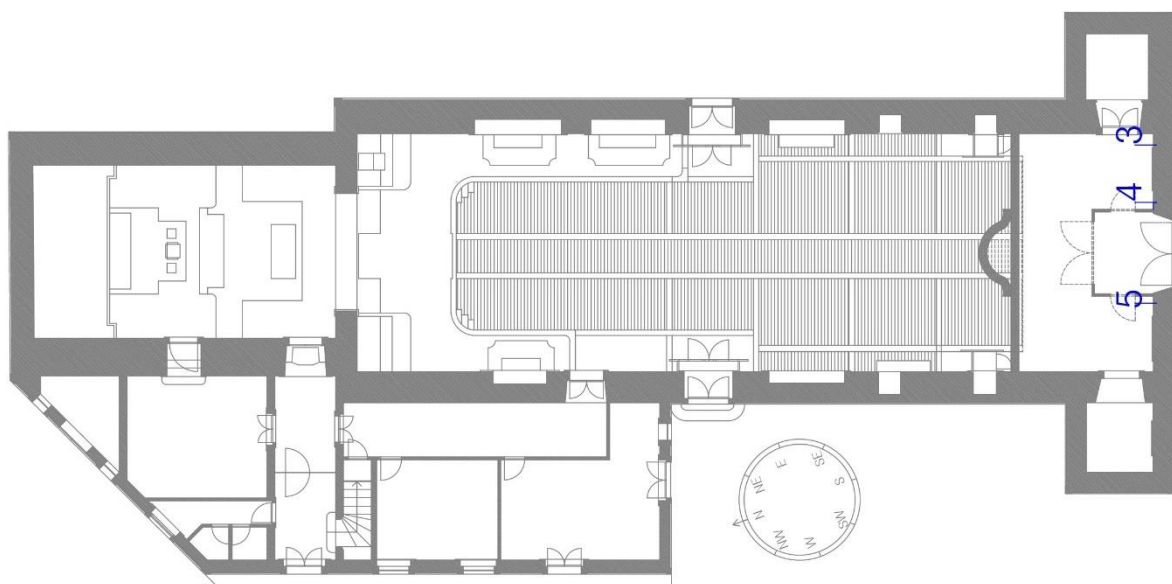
Planta do coro (piso 1) - localização do levantamento
